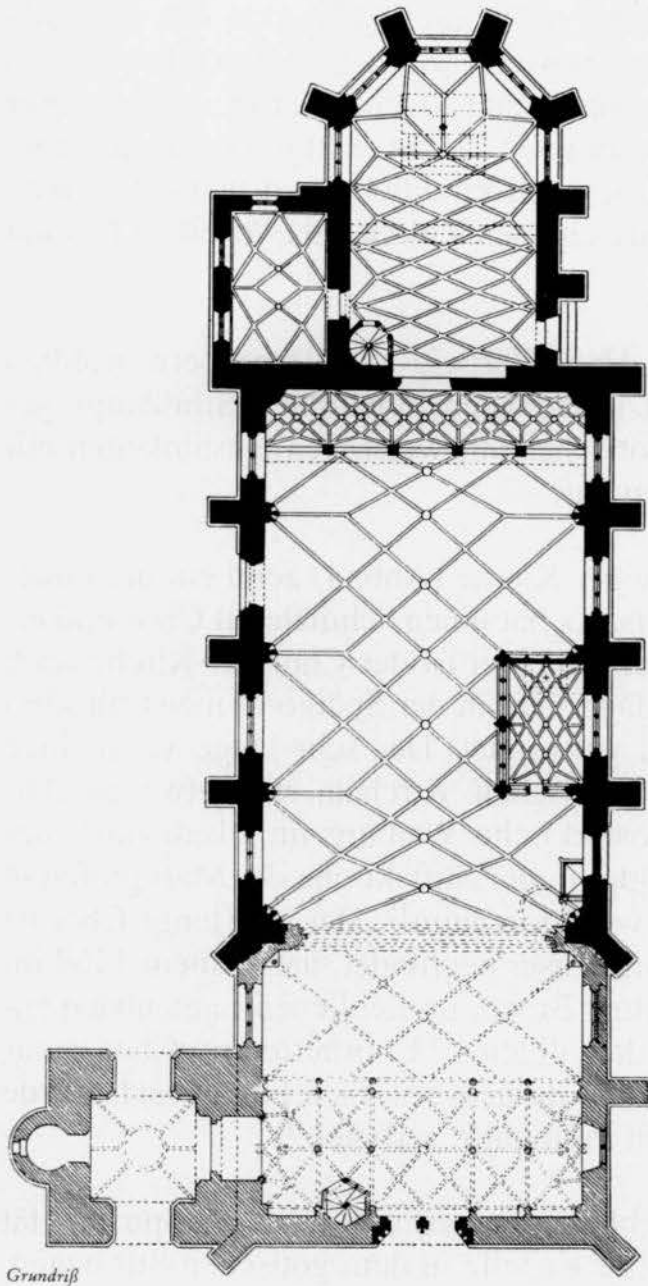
Grundriß der Lautenbacher Wallfahrtskirche
